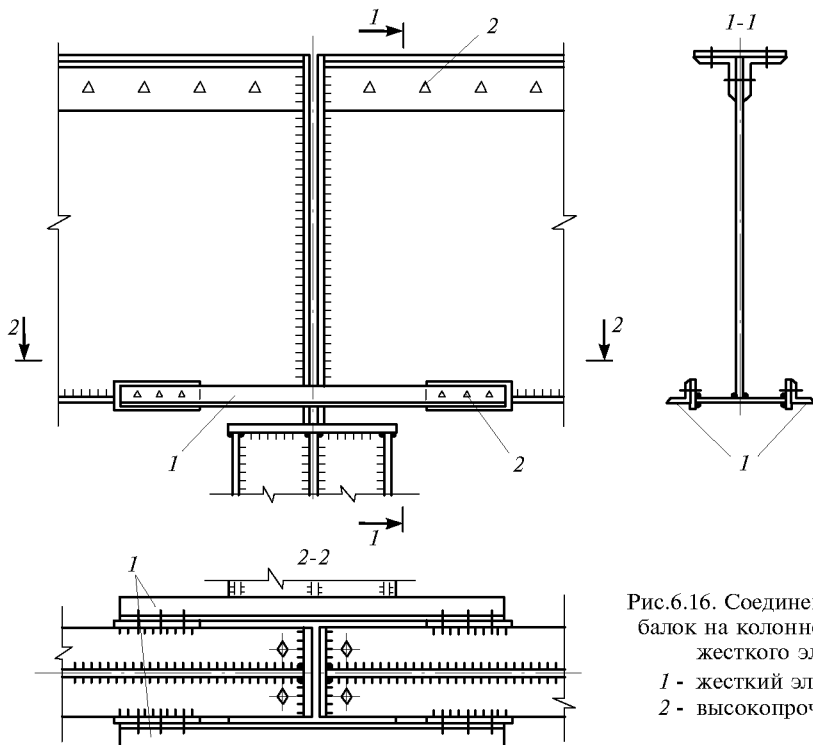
Соединение разрезных балок на колонне с помощью жесткого элемента
